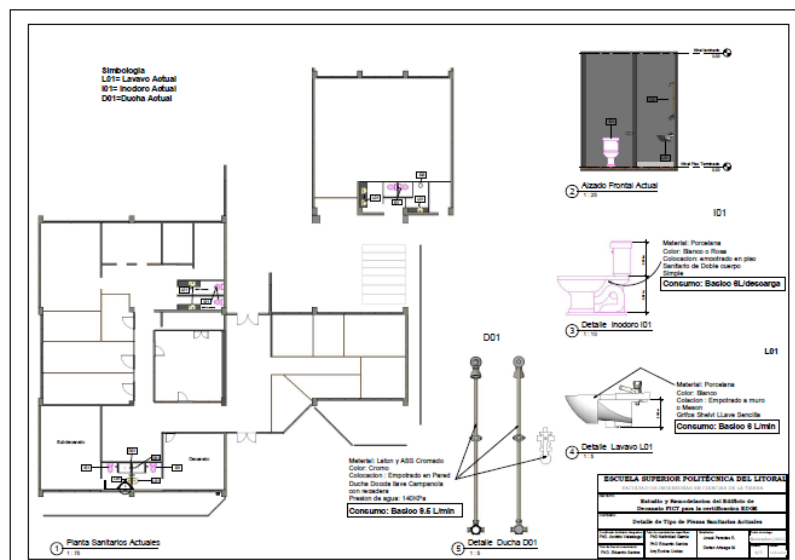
Plano con Ubicación y detalle de Piezas Sanitarias Actuales
